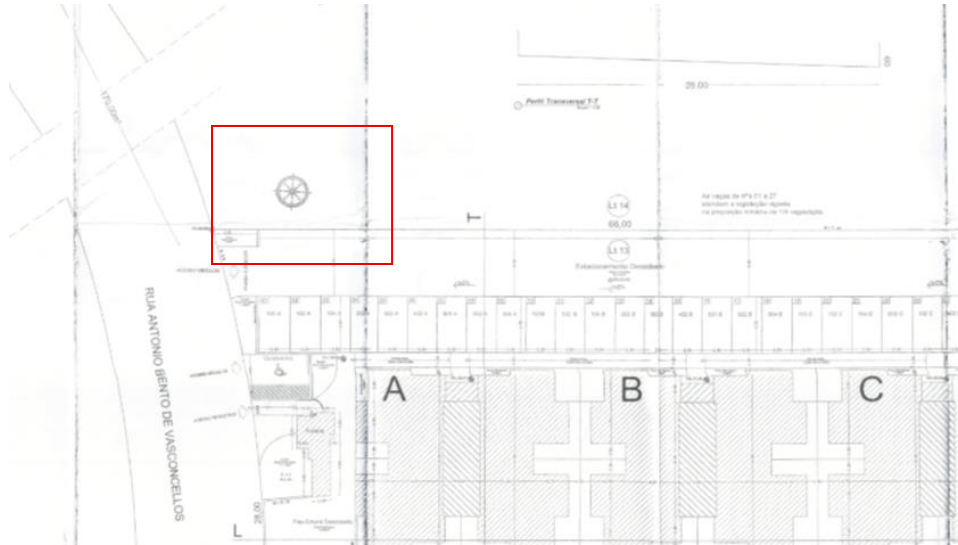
Empreendimento 1 - Planta arquitetônica sem Norte
